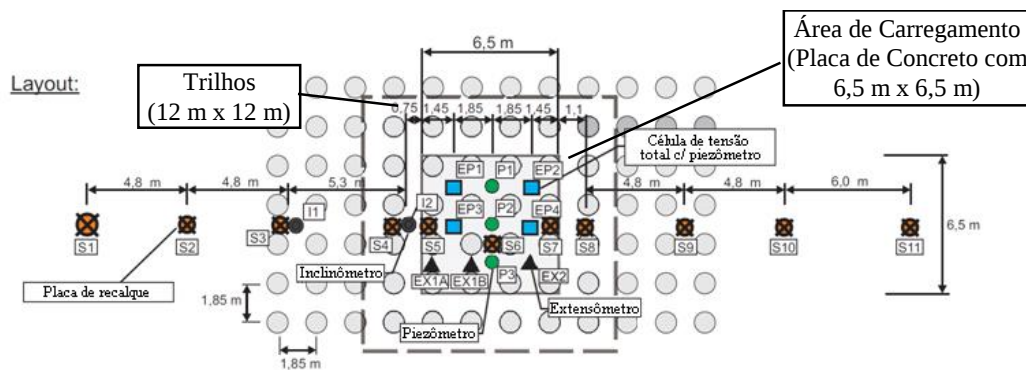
Disposição da Área Teste (TKCSA, 2007)
